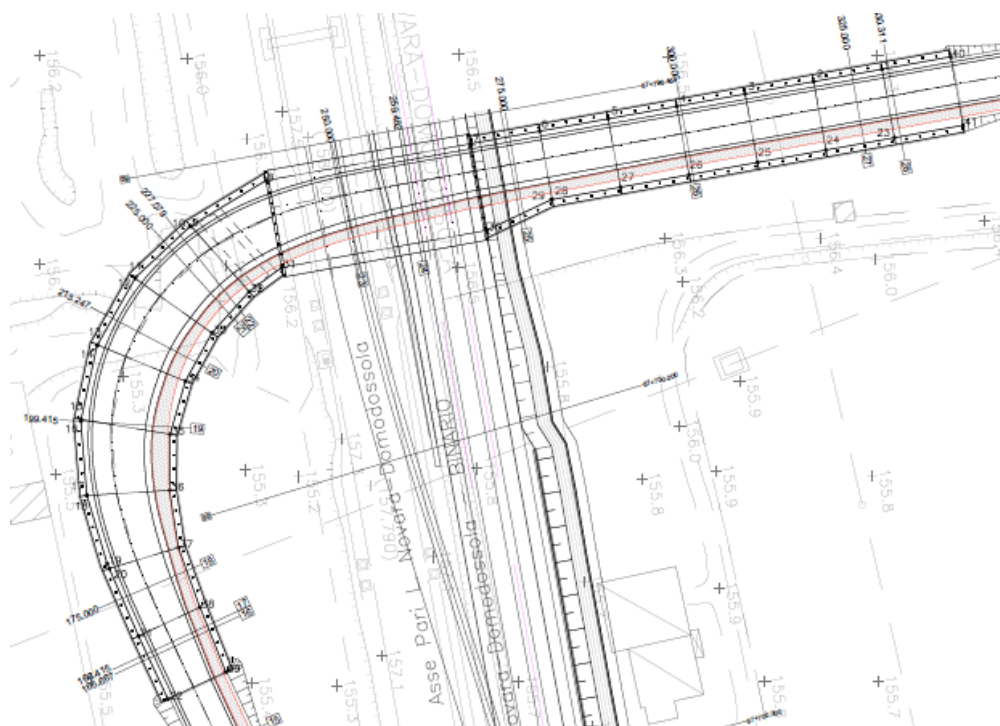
PLANIMETRIA SOTTOVIA SL01
